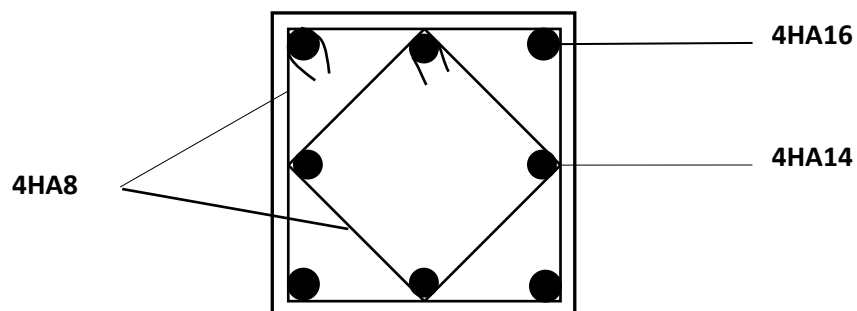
Schéma de ferrailage du poteau 5, 6, 7, 8ème, étage.
